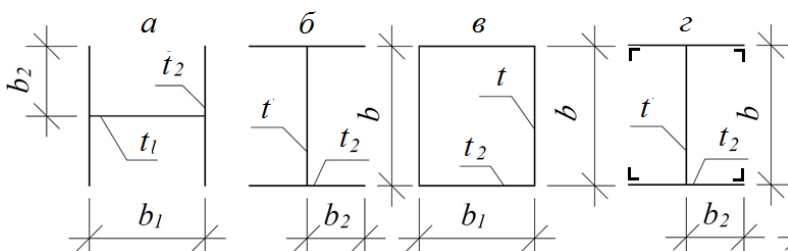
Схемы к определению предельной гибкости листов сечений ферм
